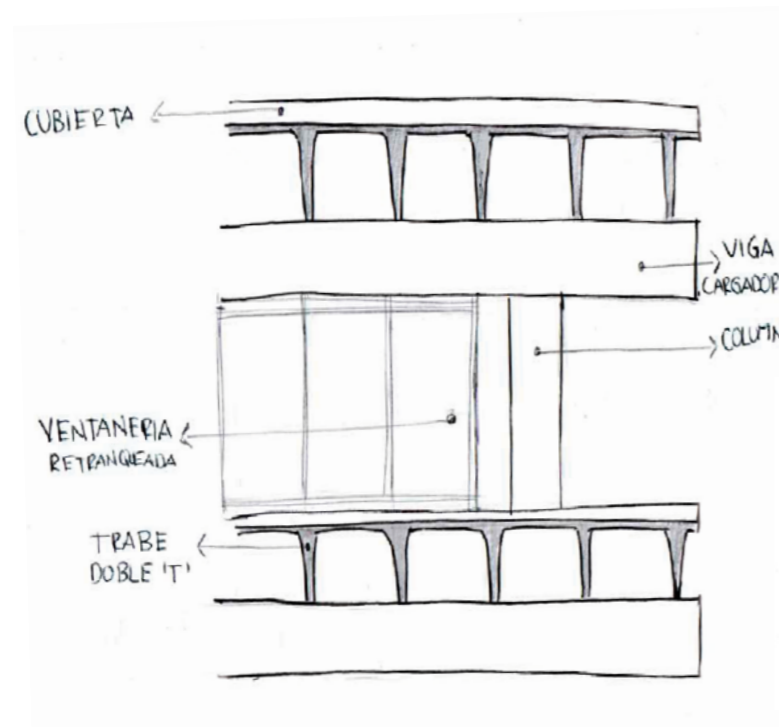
Estructura vista en fachada, Trabes doble T. Fuente propia
